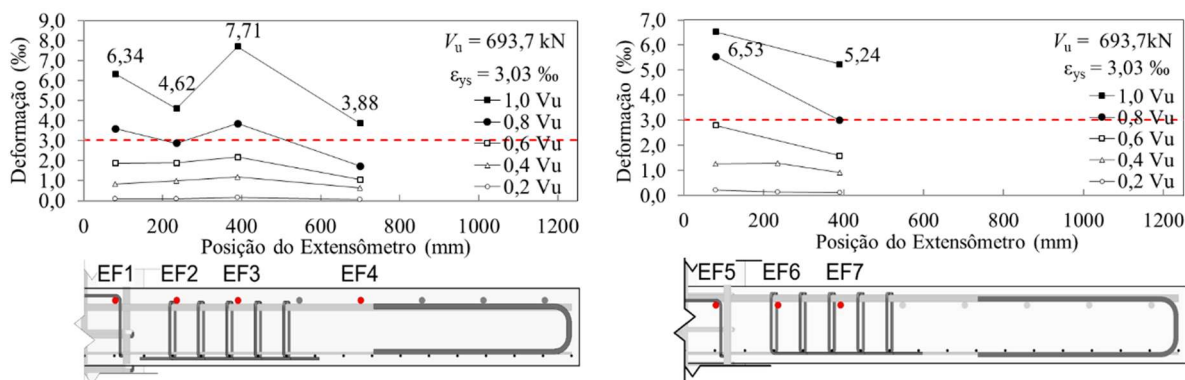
Deformações nas armaduras de flexão da laje CFA
